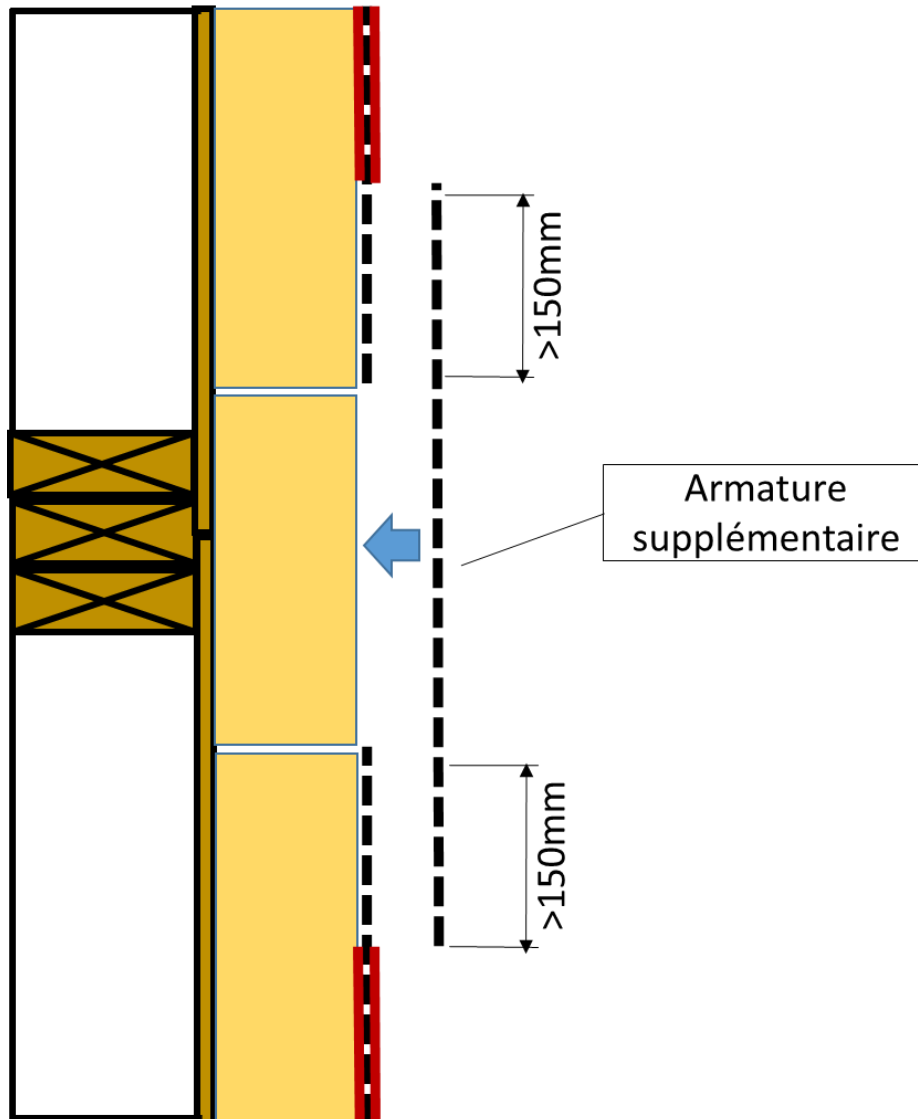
Exemple de raccord horizontal : continuité de l'enduit (coupe verticale)
